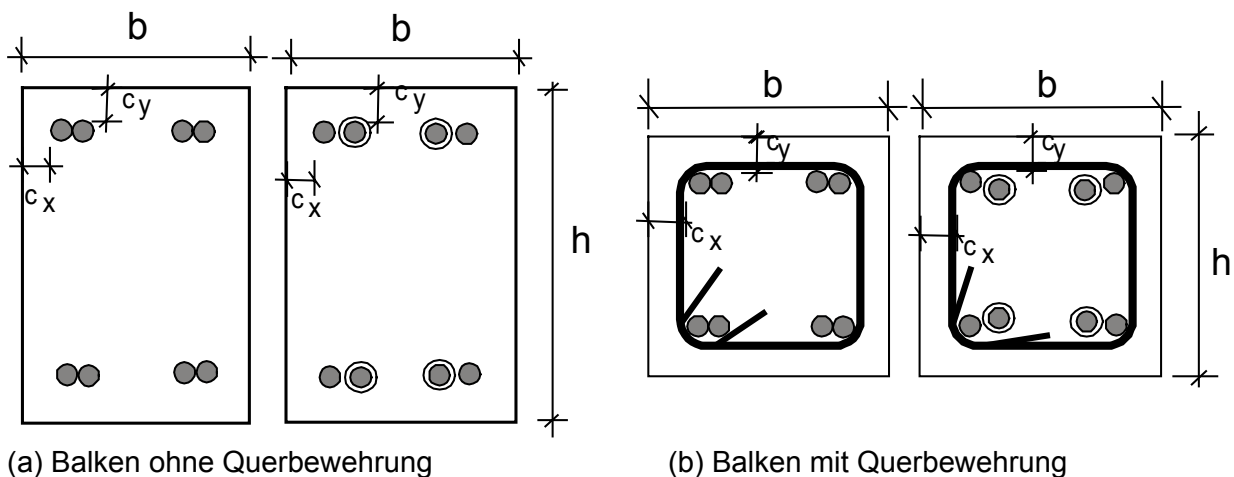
Bewehrung im Stoßbereich, Balken ohne und mit Querbewehrung
